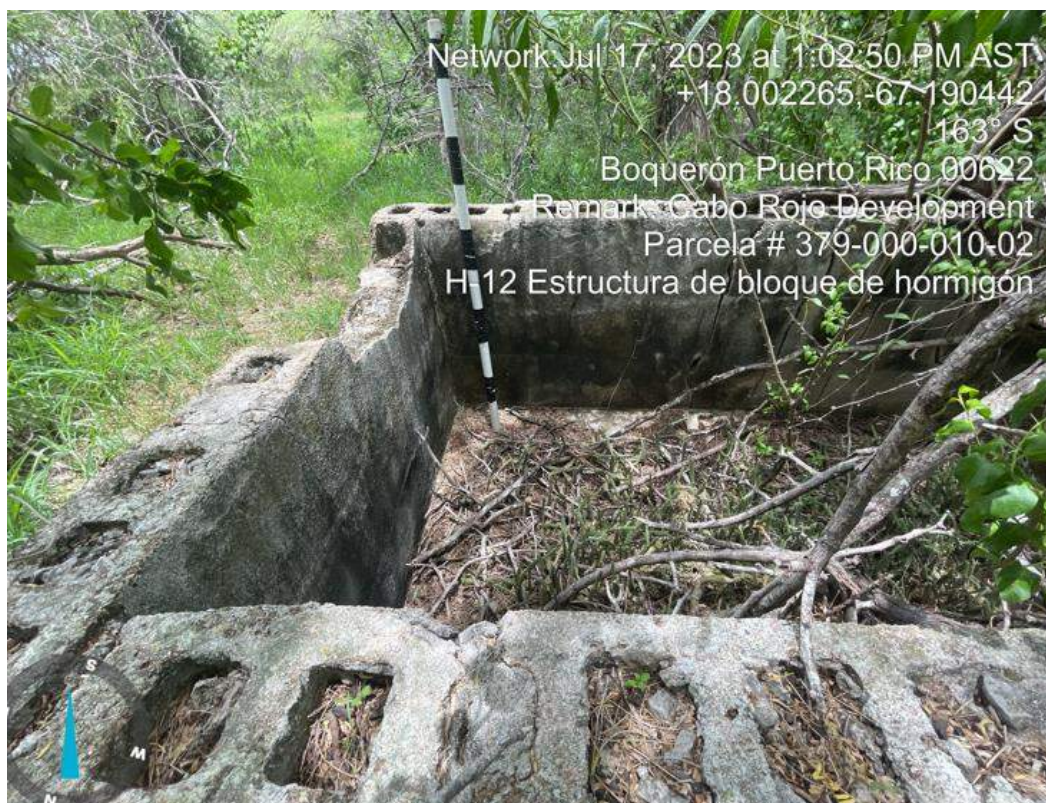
Elemento H-12, estructura de concreto, abrevadero.
